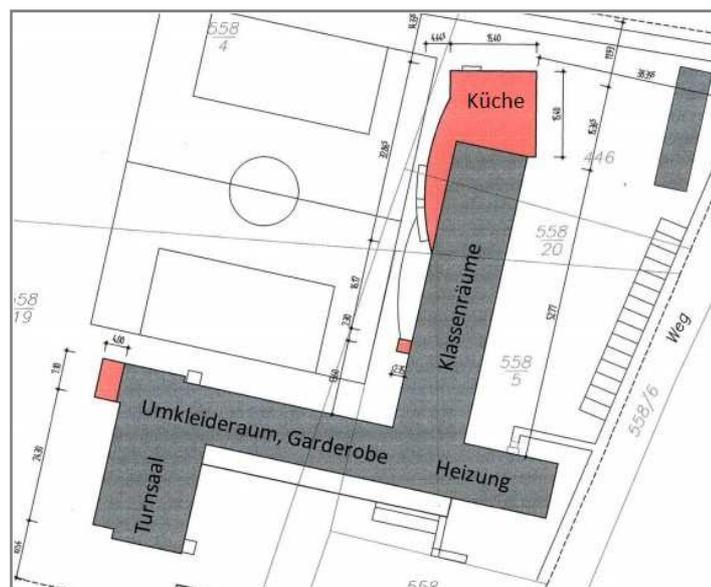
Grundriss Schule¹⁵⁷
